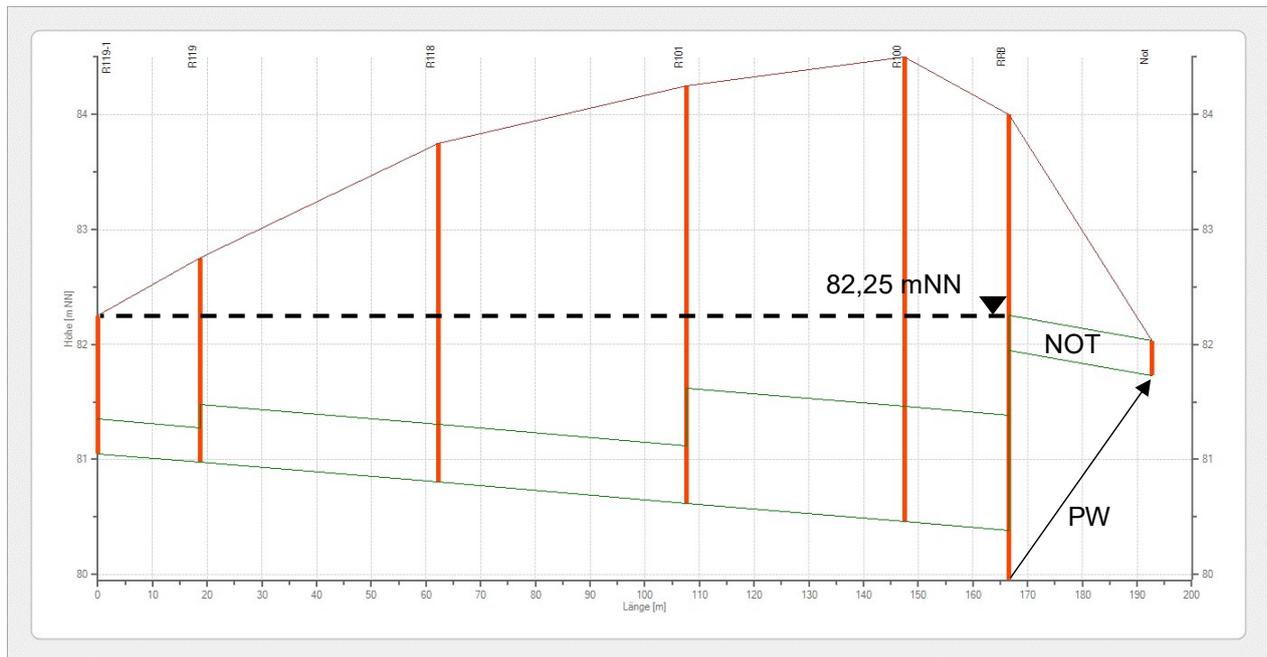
Variante 1: Längsschnitt R119-1 (Tiefpunkt) – Auslass
